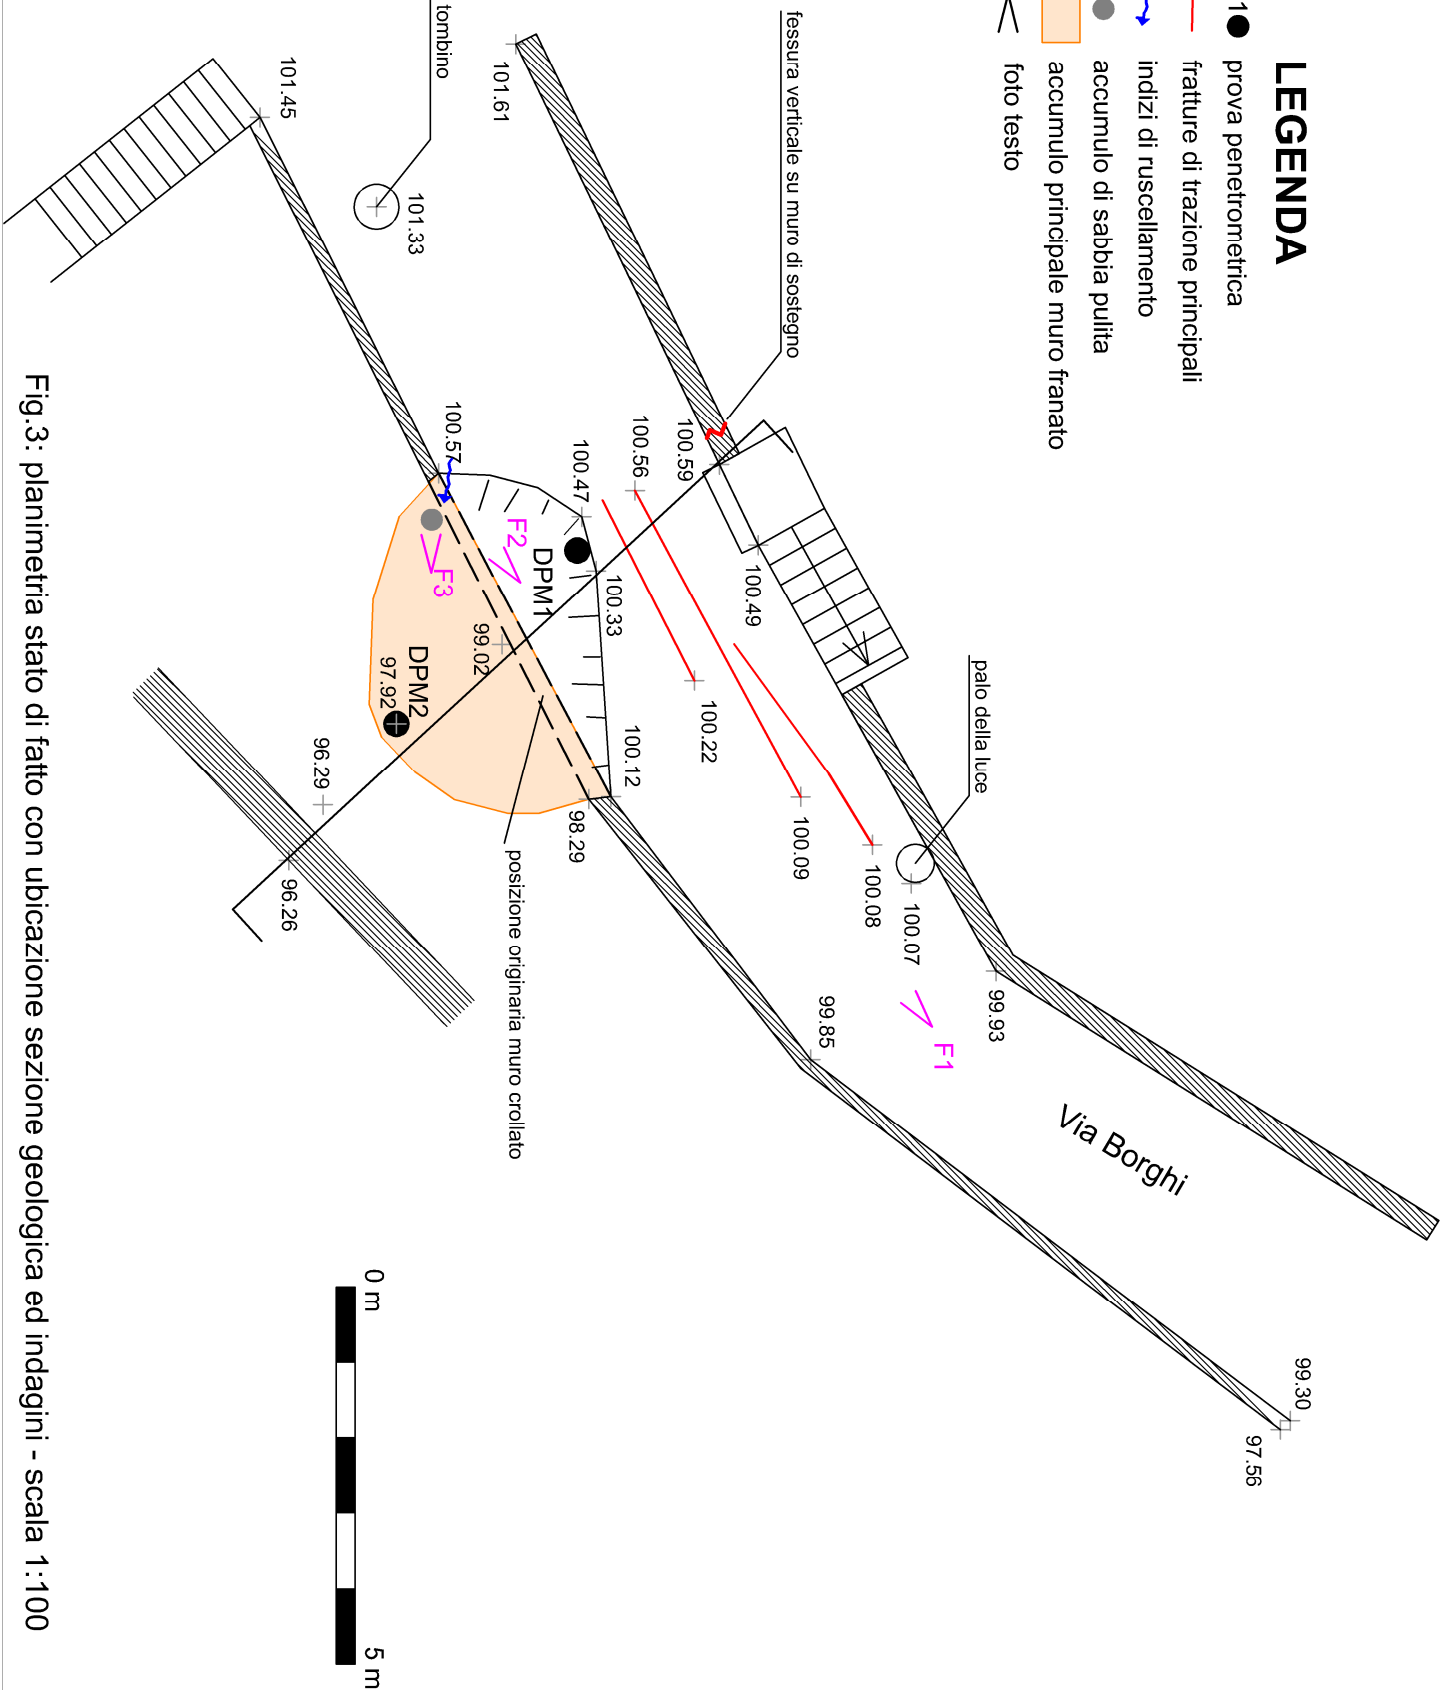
planimetria stato di fatto con ubicazione sezione geologica ed indagini - scala 1:100
